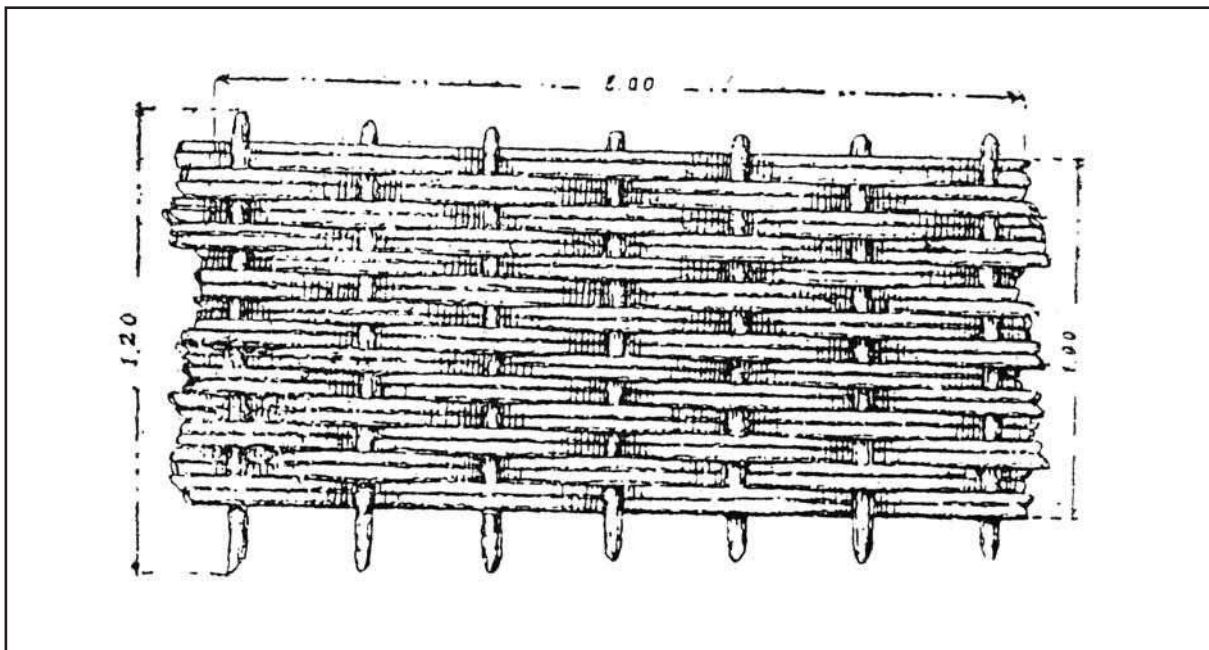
Graticcio (Istruzione n. 104 sui lavori da zappatore - Ministero della guerra 1912)
